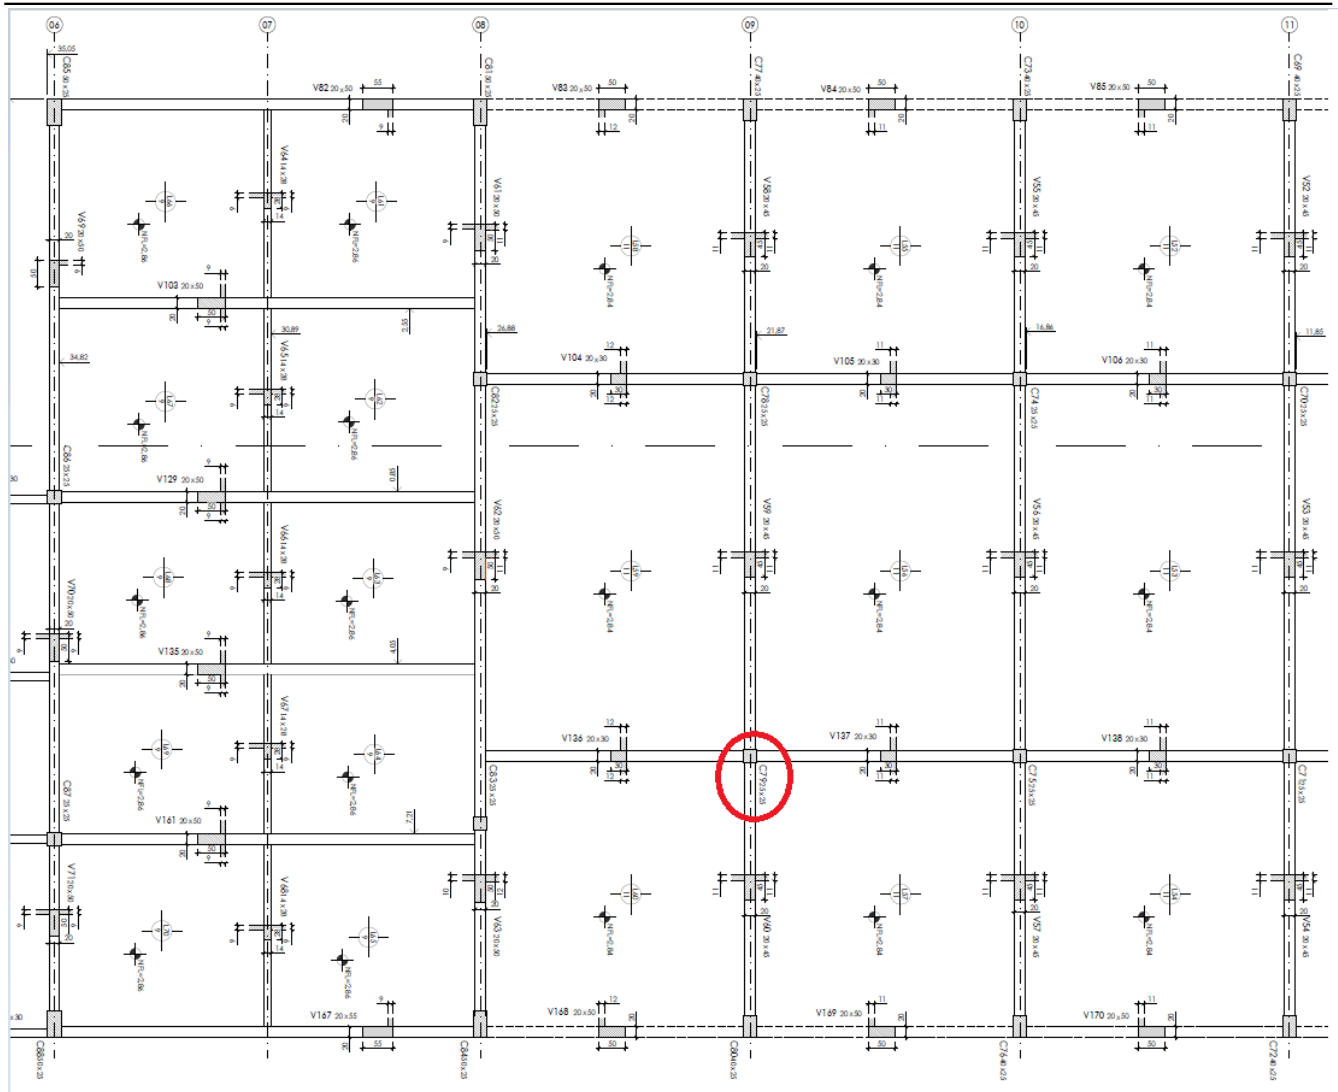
Esquema estructural de vigas y columnas. (Fuente: Elaboración propia)
